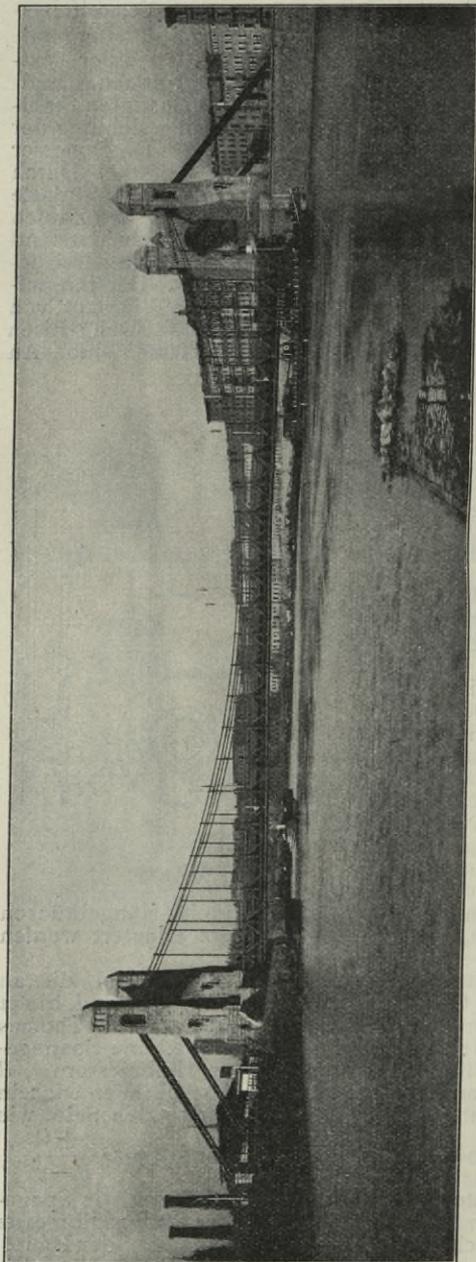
Gesamt-Ansicht der Kaiser Wilhelm-Brücke in Breslau.
